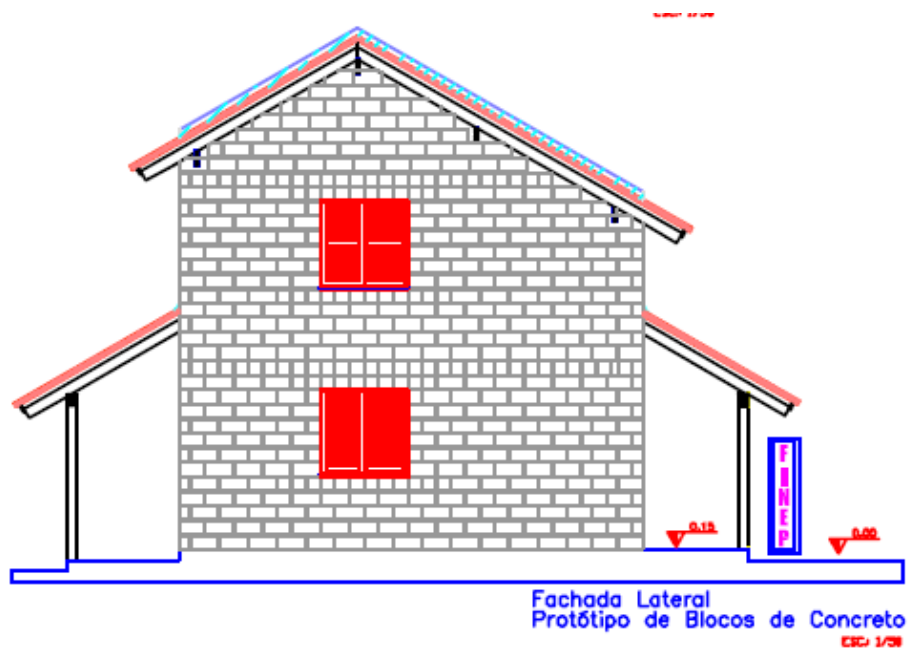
Fachada. Fonte: Rocha (2010)²⁷.
